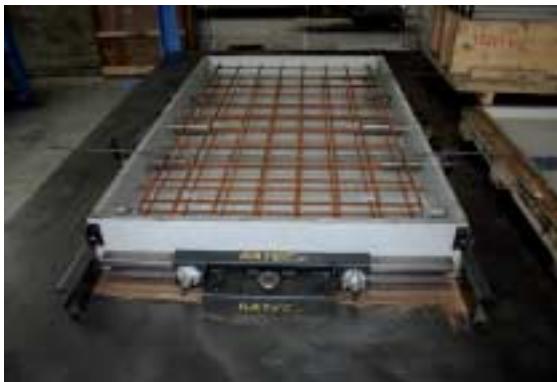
Encofrado cerrado y armado con placas alkus para elementos de senderos.
